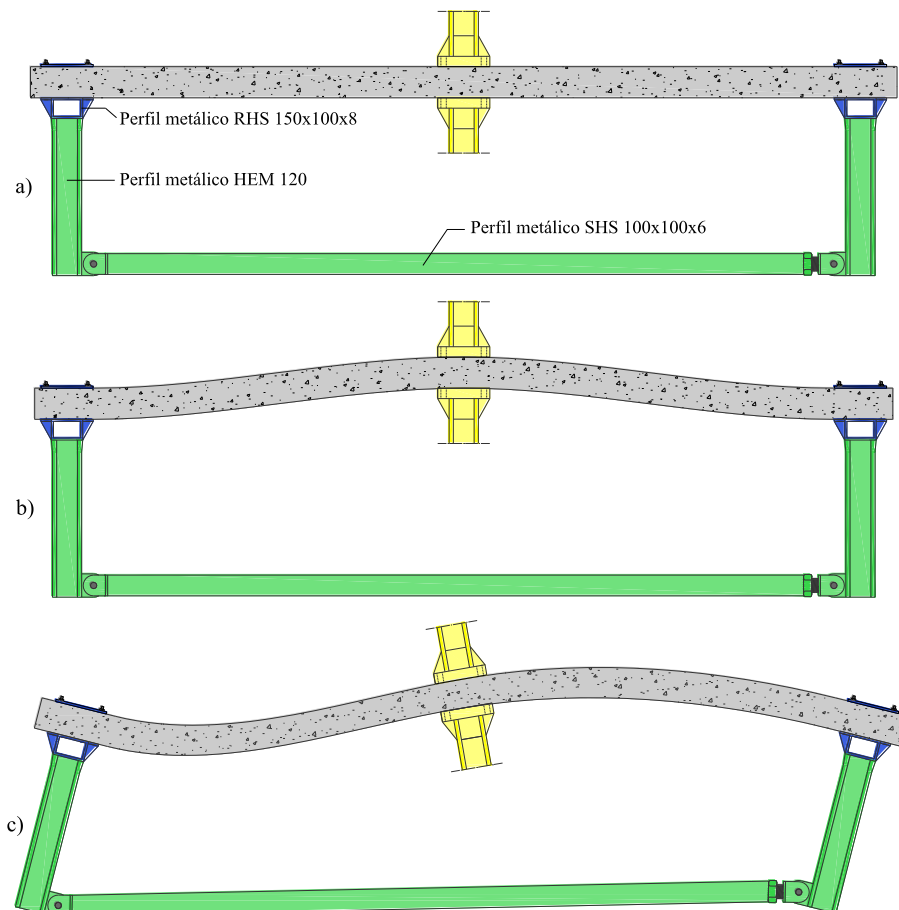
Sistema de aplicação das cargas verticais e da ação horizontal (dimensões em mm).
